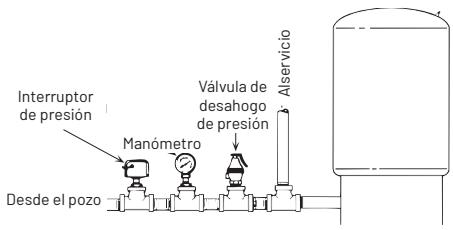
Instalación típica con un tanque precargado vertical y bombas de pozo sumergibles
